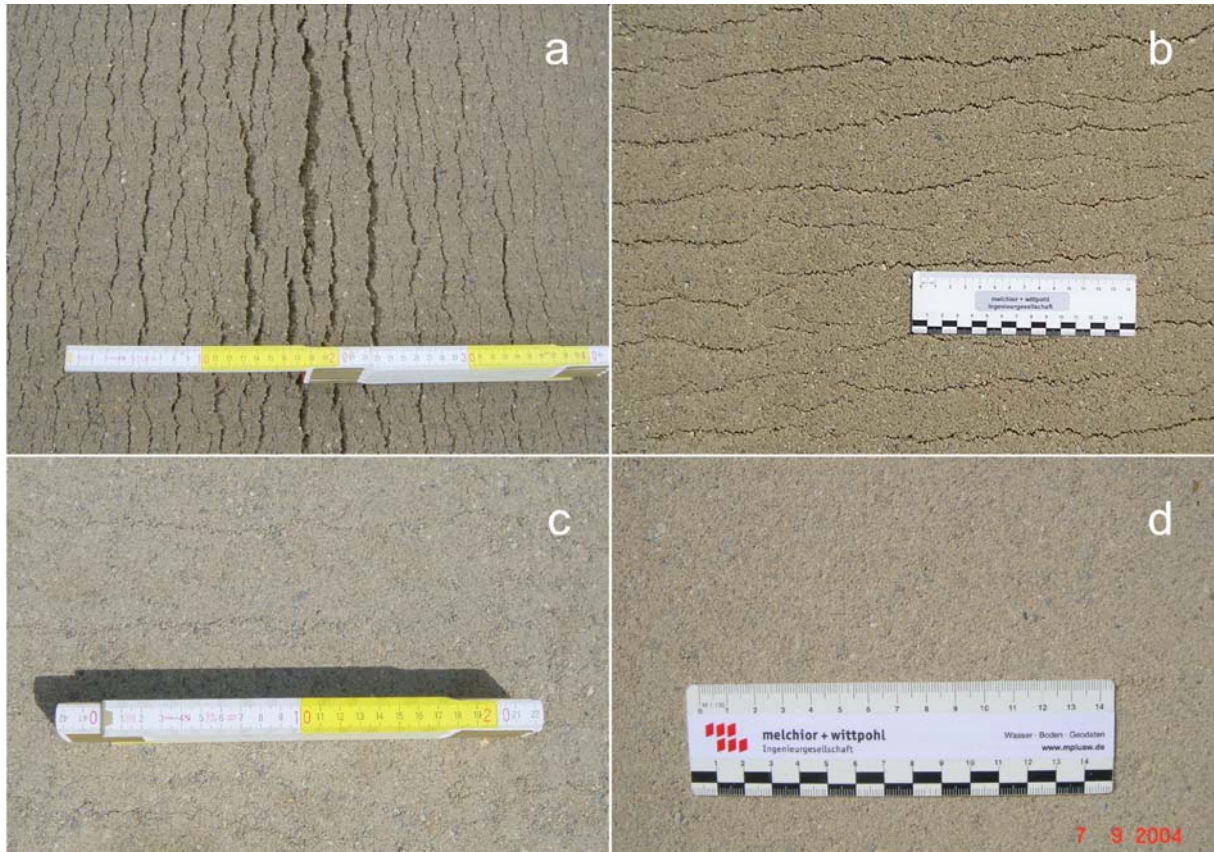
Struktur der Dichtungsoberfläche während der Herstellung mit Fertiger und Walzen:
